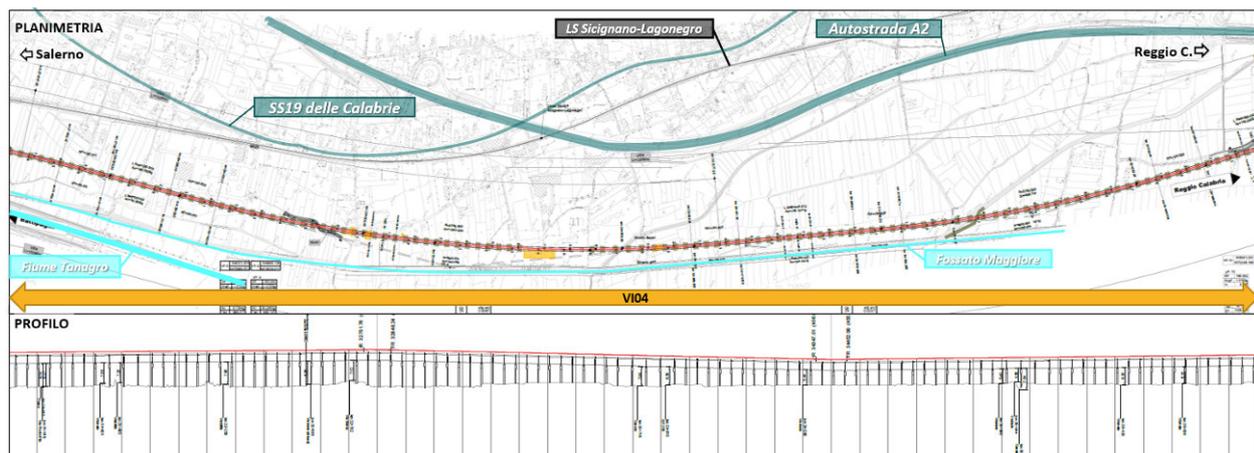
Planopprofilo di progetto da km 32+300 a km 35+100
